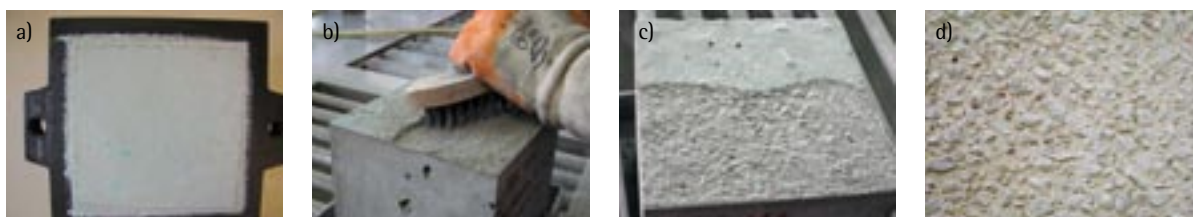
Herstellung der Waschbetonoberflächen im Labor; a) Würfel mit aufgespritztem Oberflächenverzögerer (Kombinationsmittel); b) Ausbürsten der Oberfläche nach 24 Stunden mit einer Stahlbürste; c) ausgebürstete Teilfläche; d) fertig ausgebürstete Waschbetonoberfläche
